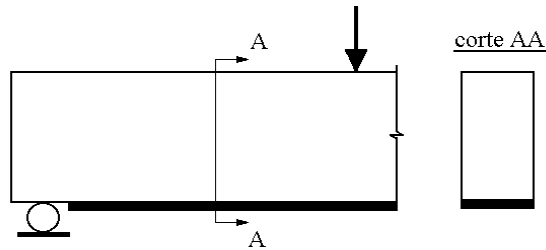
Exemplo de Reforço à Flexão de Vigas no Bordo Inferior
